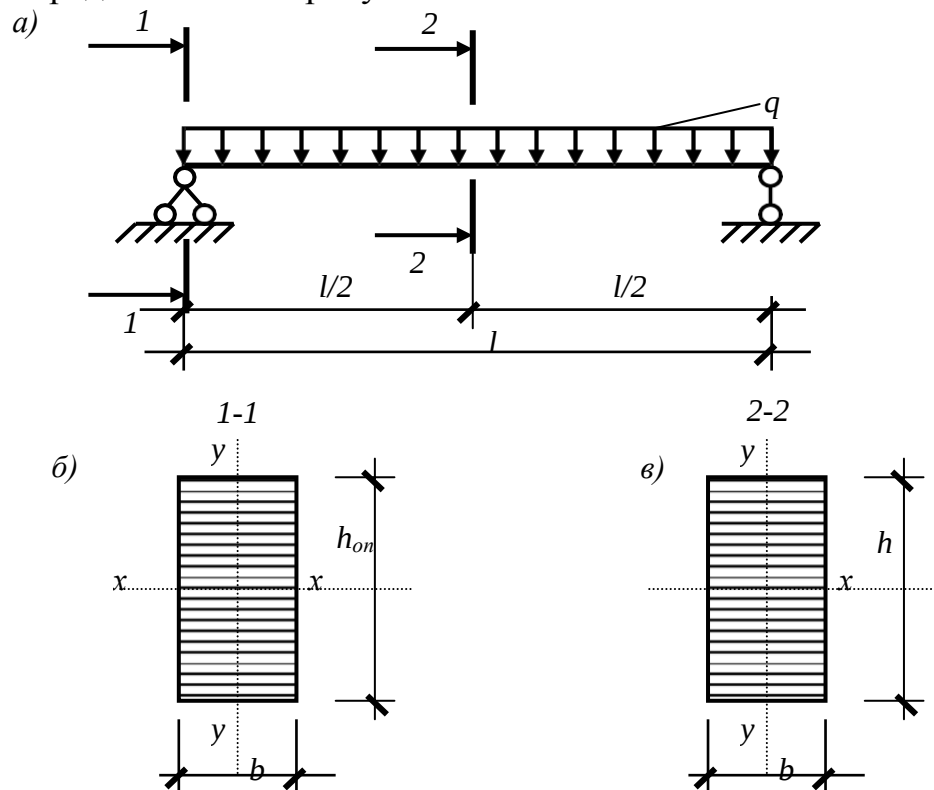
Расчетная схема и сечения балки: а – расчетная схема; б – расчетное поперечное сечение на опоре; в – то же в середине пролета
